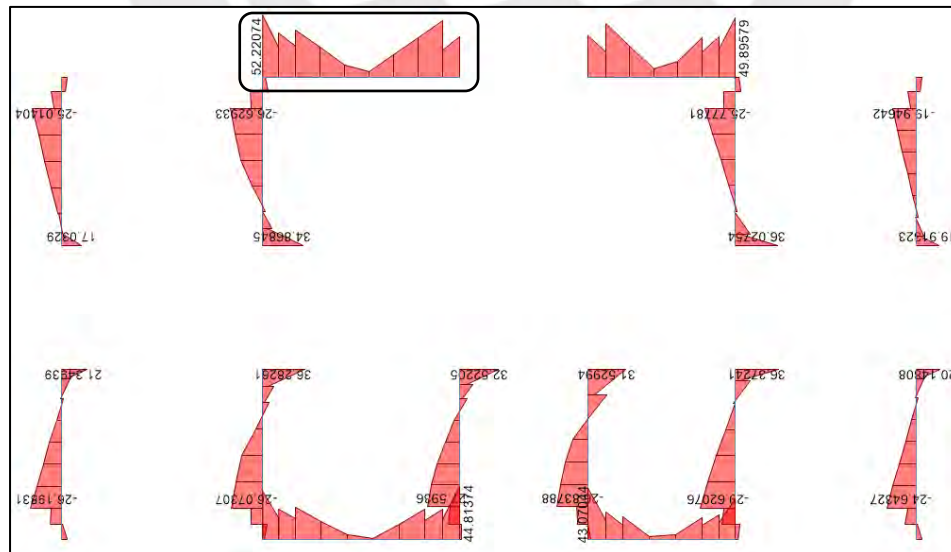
Envolvente positiva del DMF en vigas de cimentación
